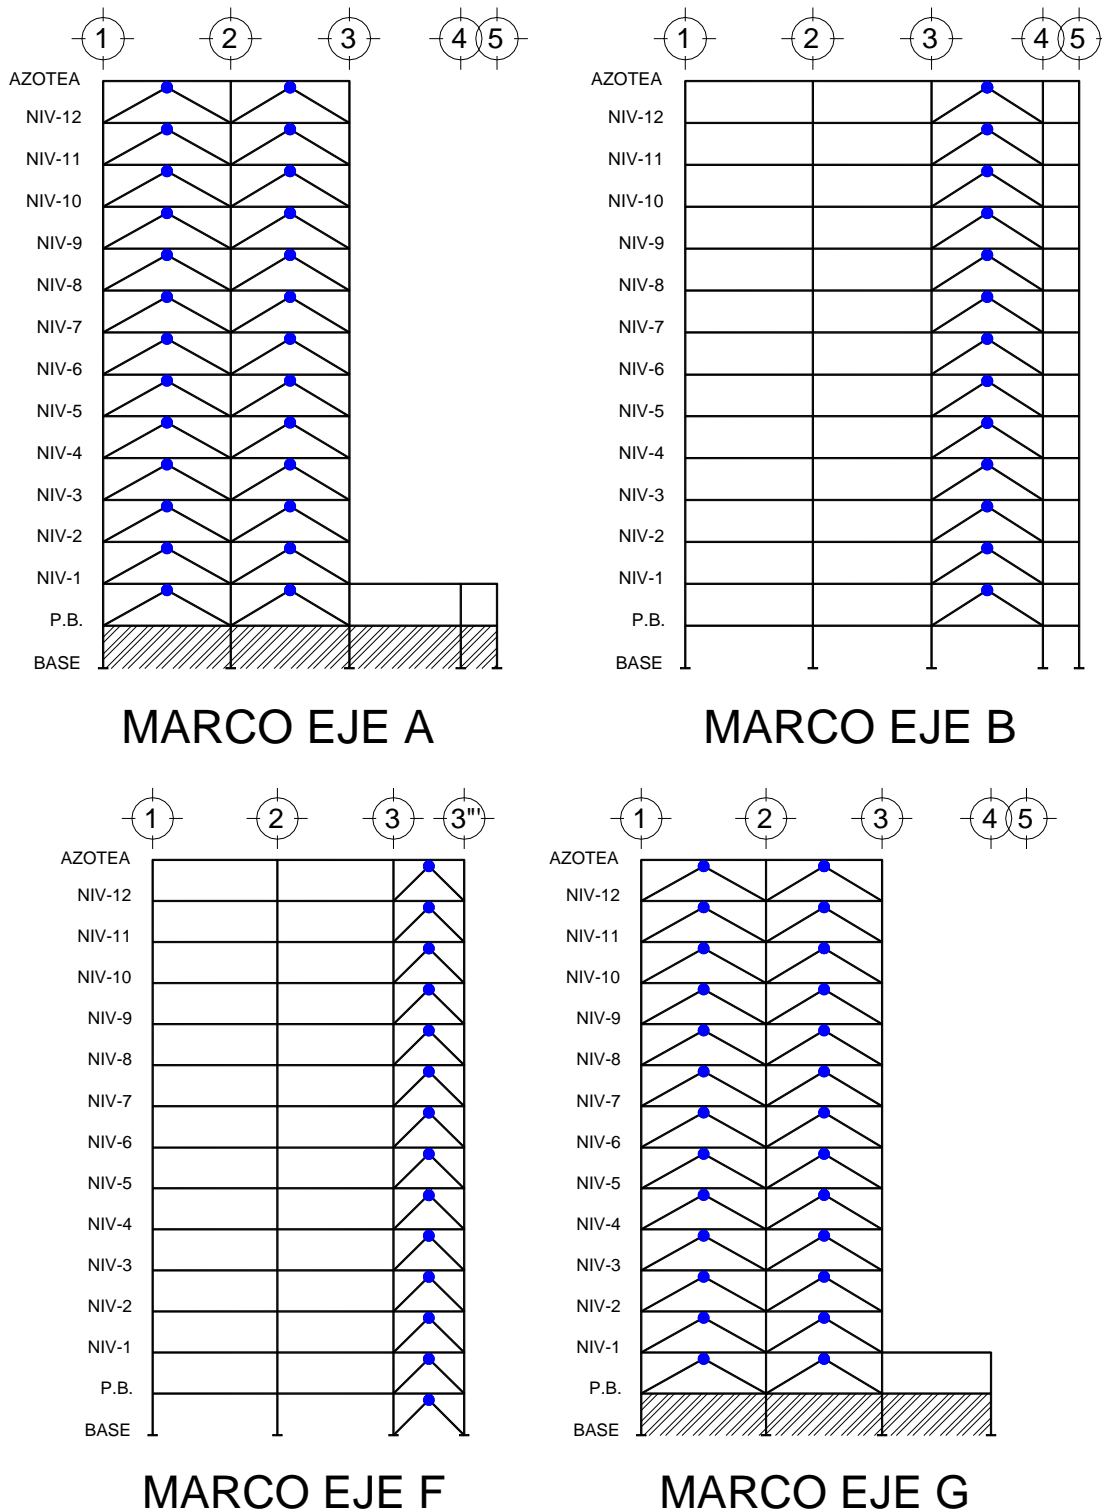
Articulaciones plásticas en la estructura antes de la primera fluencia en un elemento de concreto reforzado, marcos transversales.
